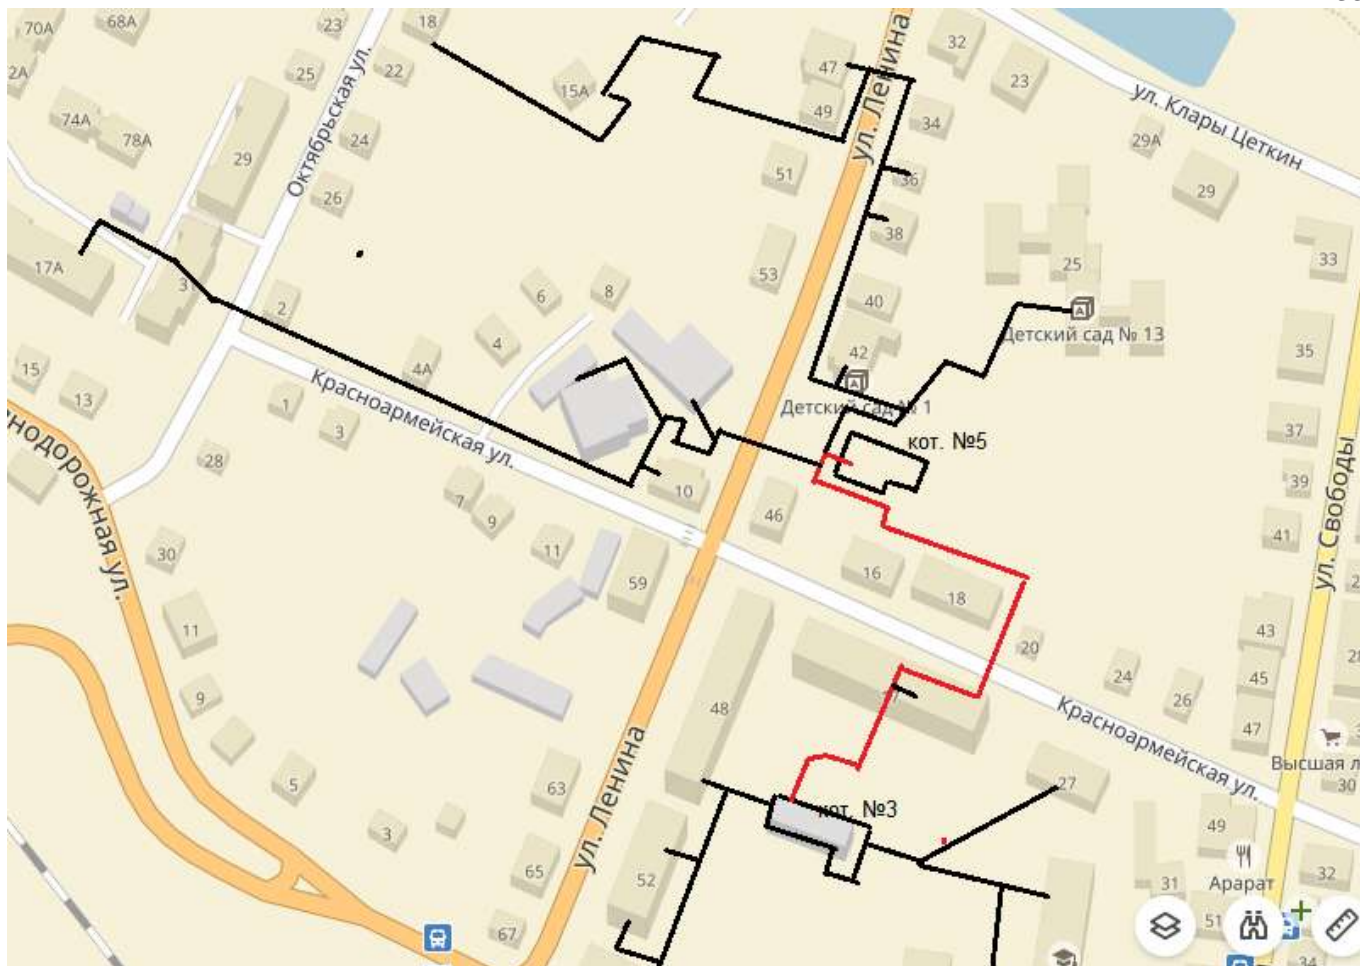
Схема прокладки соединительного участка теплосети котельная №3 – котельная №5
